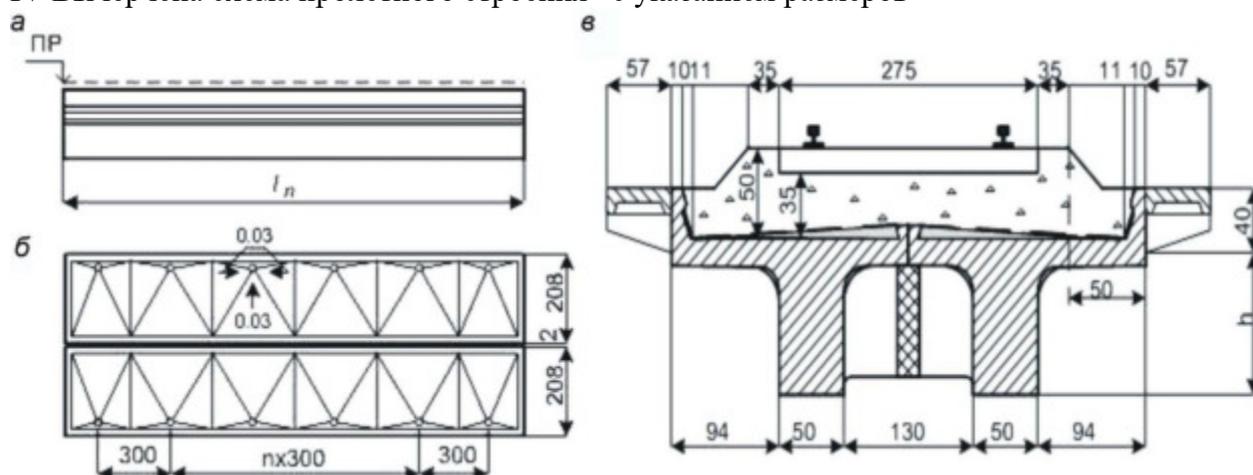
Схема железобетонного ребристого пролетного строения: а – вид вдоль оси моста; б – план балластного корыта; в – поперечное сечение
